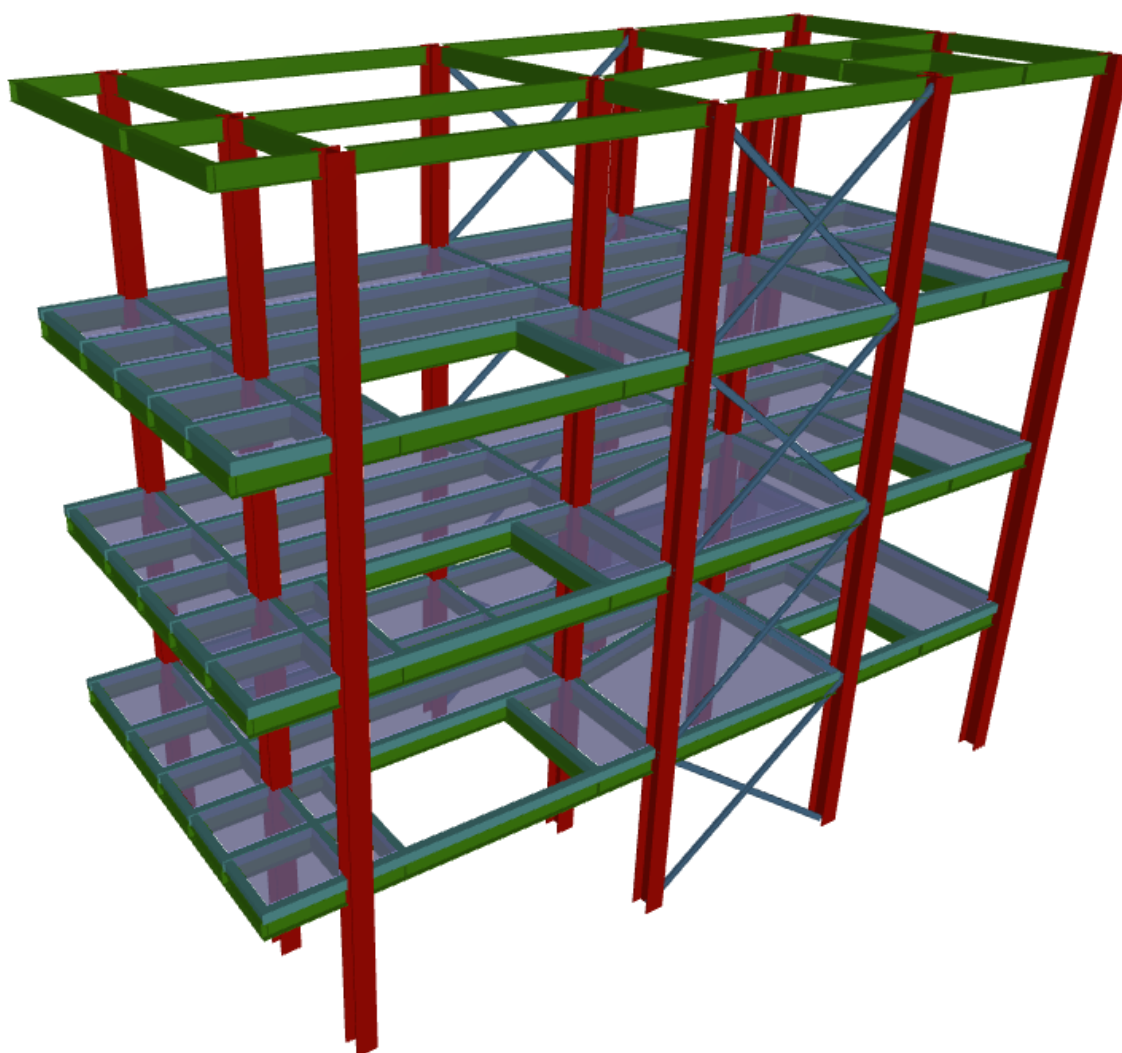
Modelo estructural con pórticos metálicos en CYPECAD.
